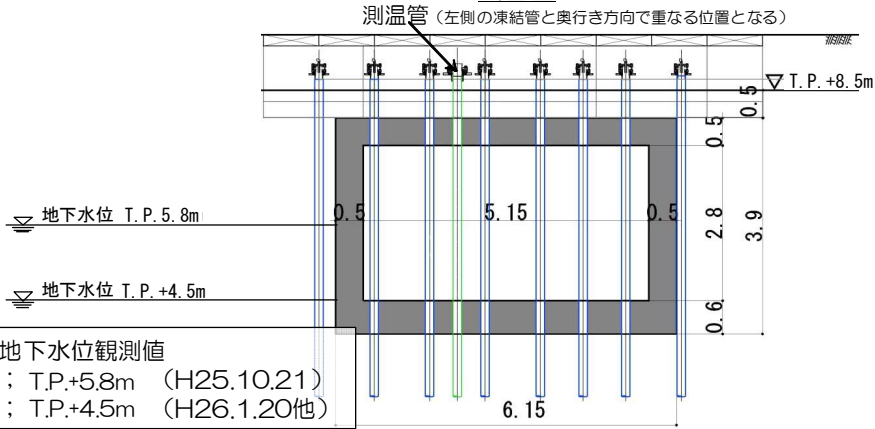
【9-2】配管ダクト 施工方法（貫通施工）
